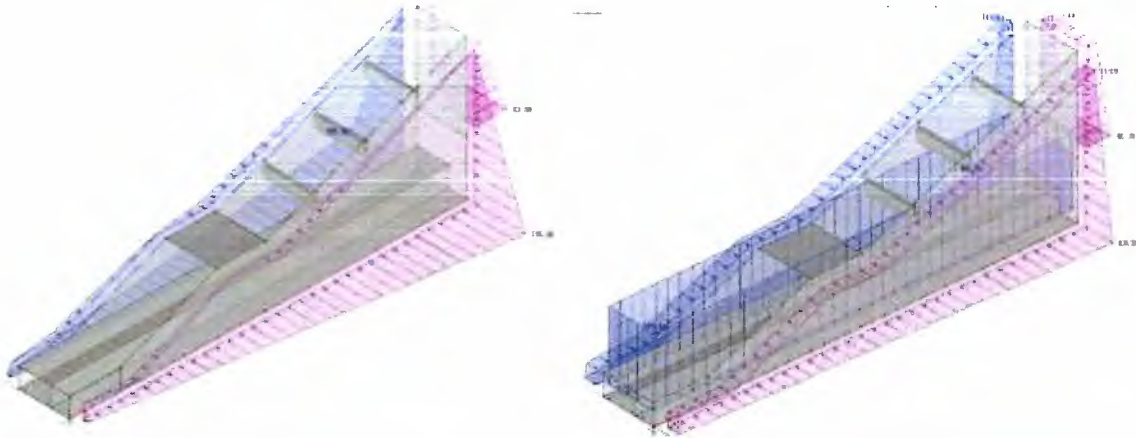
Einwirkungen auf Einlaufbauwerk Grundablass: links EK1, rechts EK2; aus Vorstatik
